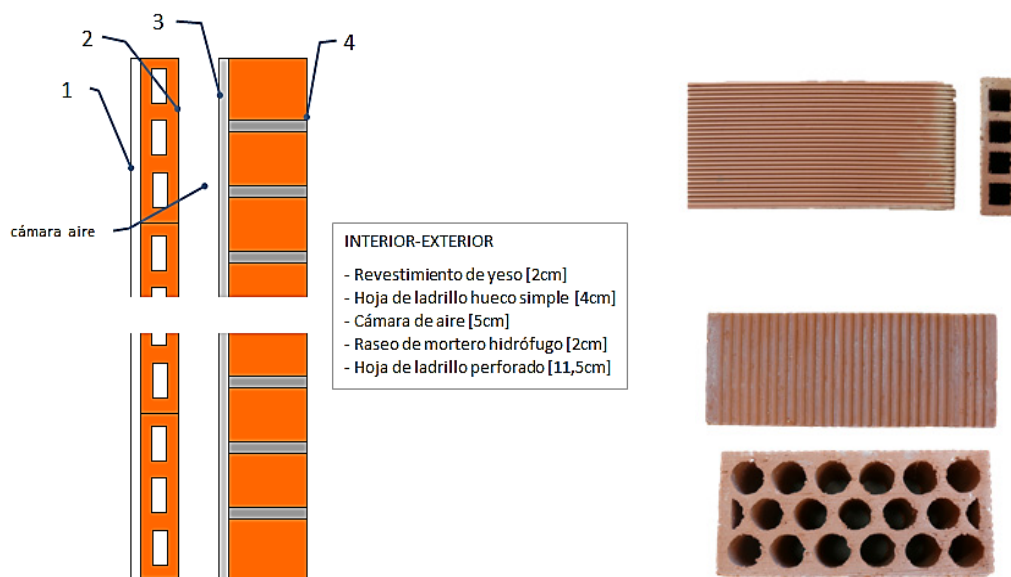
Solución constructiva del muro base, y bloques cerámicos empleados en la construcción de cada hoja de la fachada
